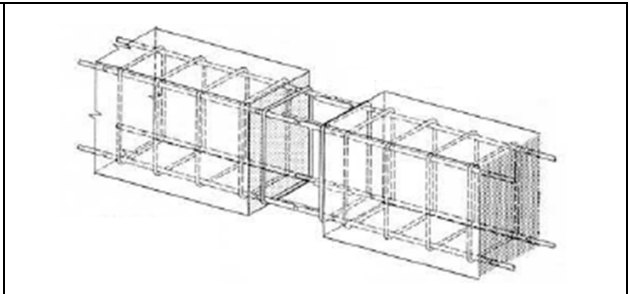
Ligação por betonagem *in situ* (Stupré, 1981)
